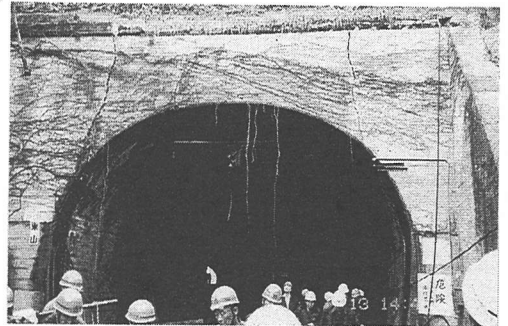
東山トンネル坑門のひび割れ¹⁾
